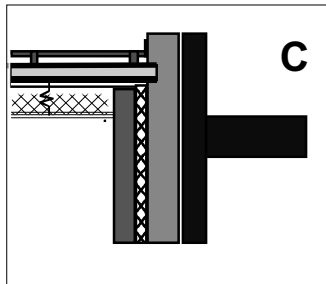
Réalisation d'un plafond acoustique désolidarisé du plancher haut du restaurant
